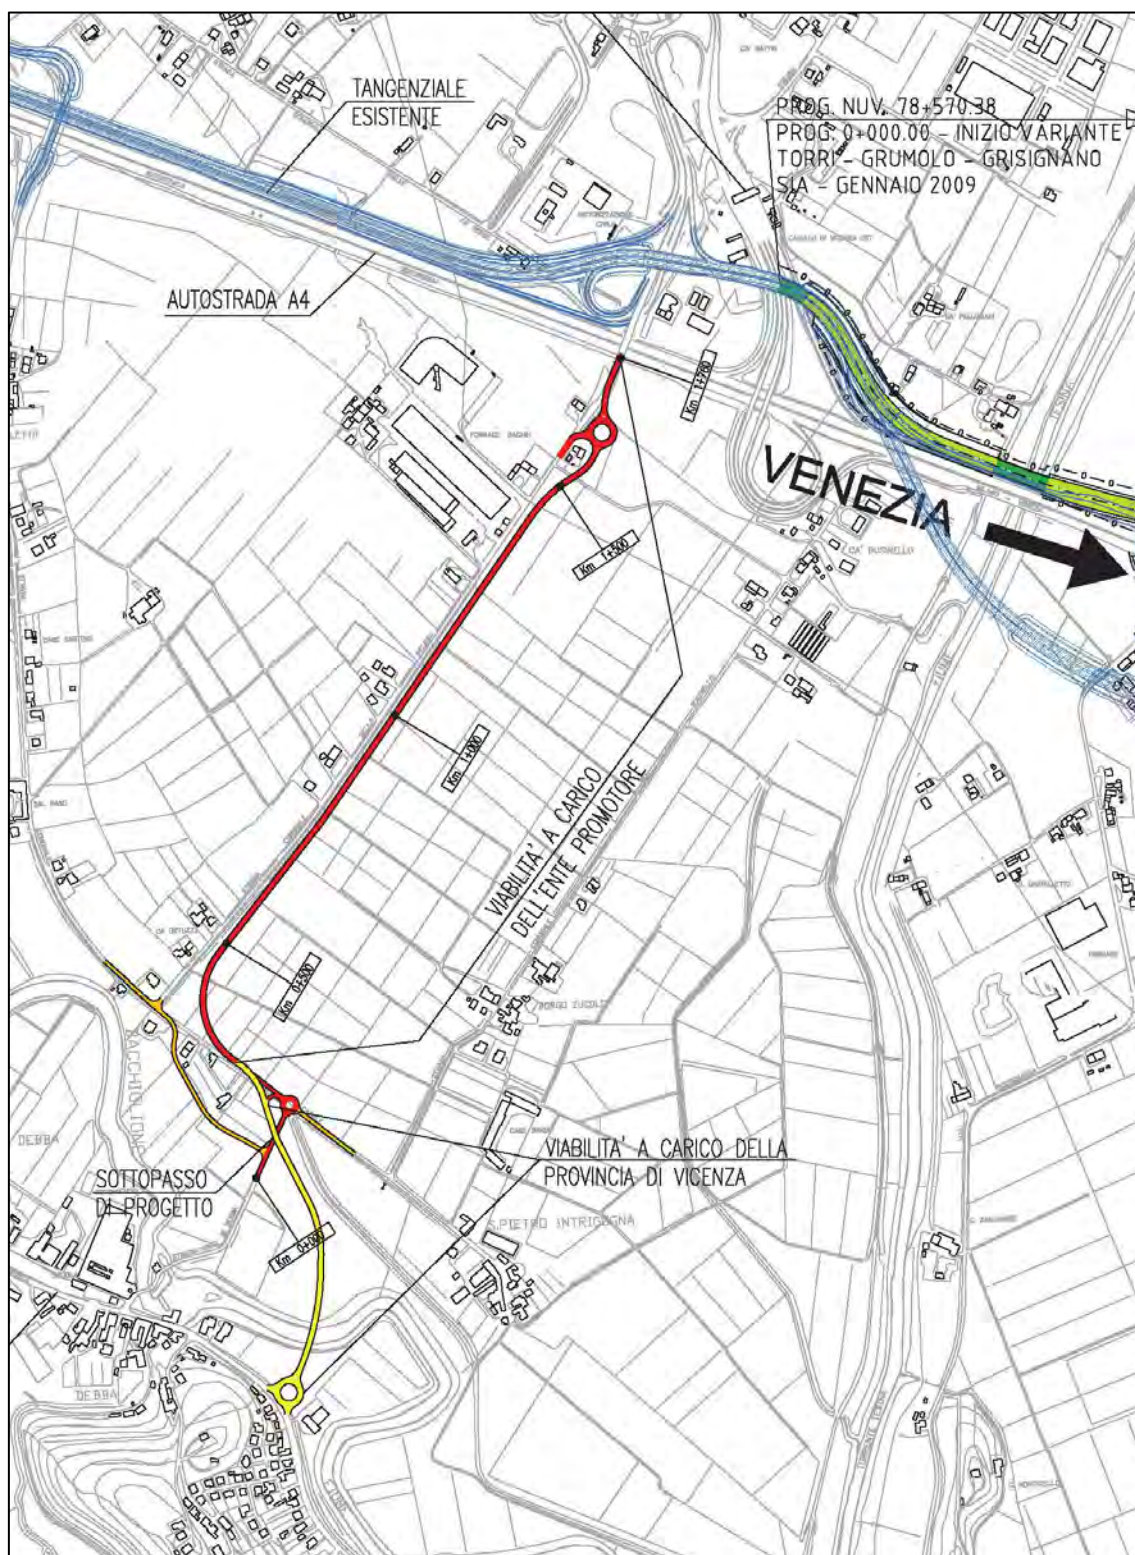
Ingrandimento planimetria osservazioni sistema delle Tangenziali Venete
